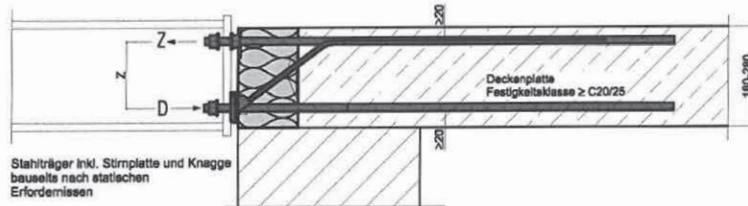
Schöck Isokorb® Typ KSXT14 VV
